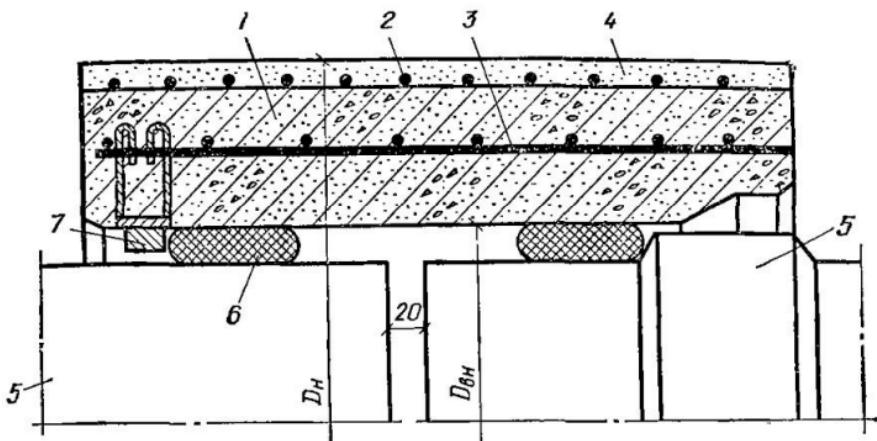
Стыковое соединение с применением железобетонной предварительно напряженной муфты
